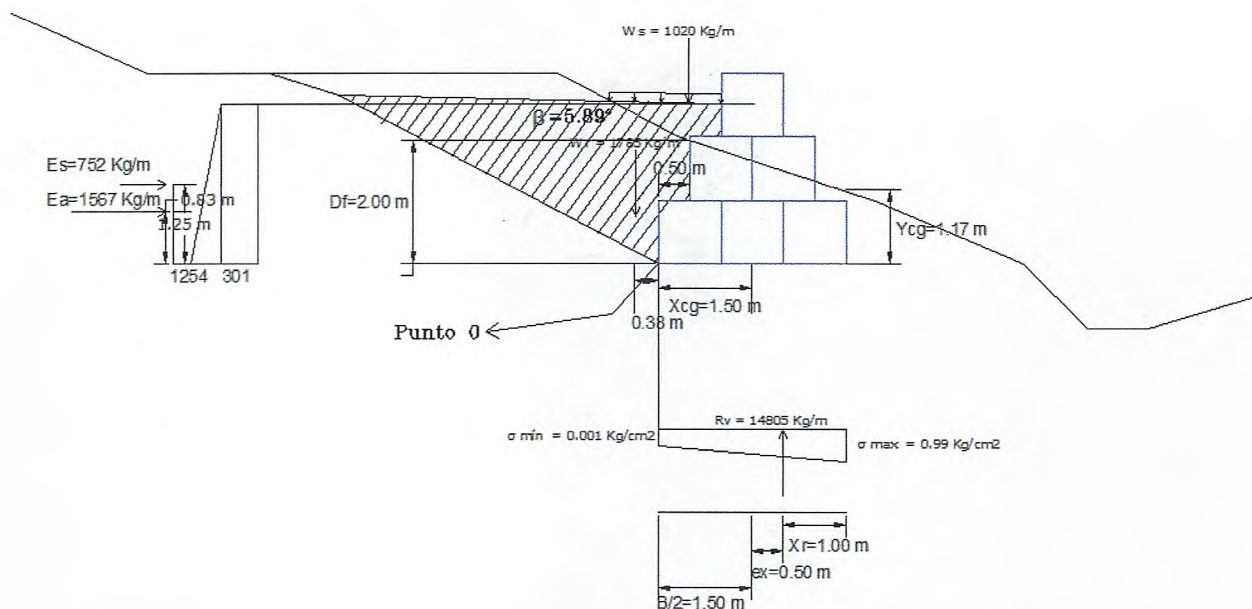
SECCION 1, Esquema de Esfuerzos Caso 1 Empuje de Tierra + Sobrecarga
